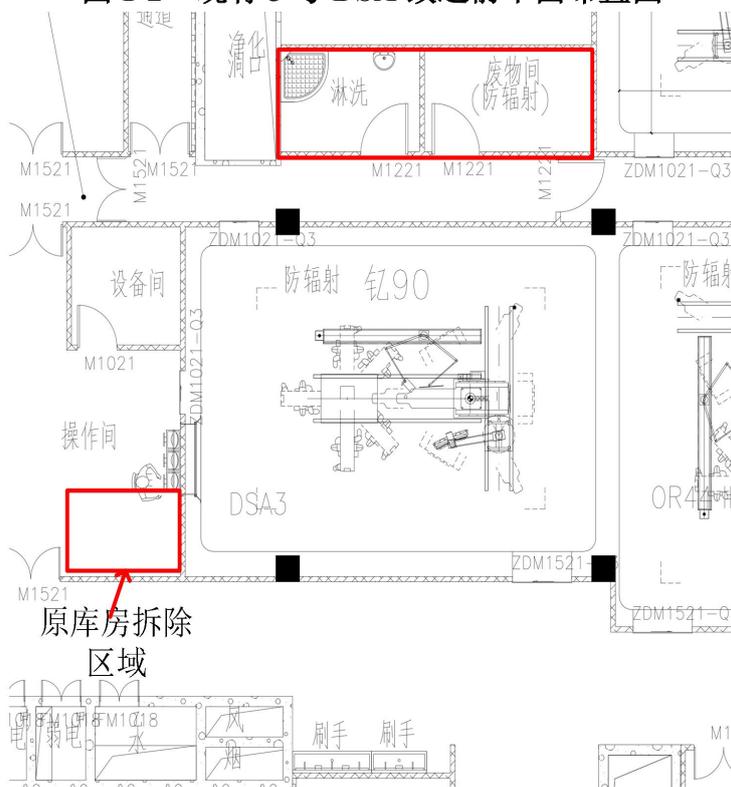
现有 3 号 DSA 机房改造后平面布置图
